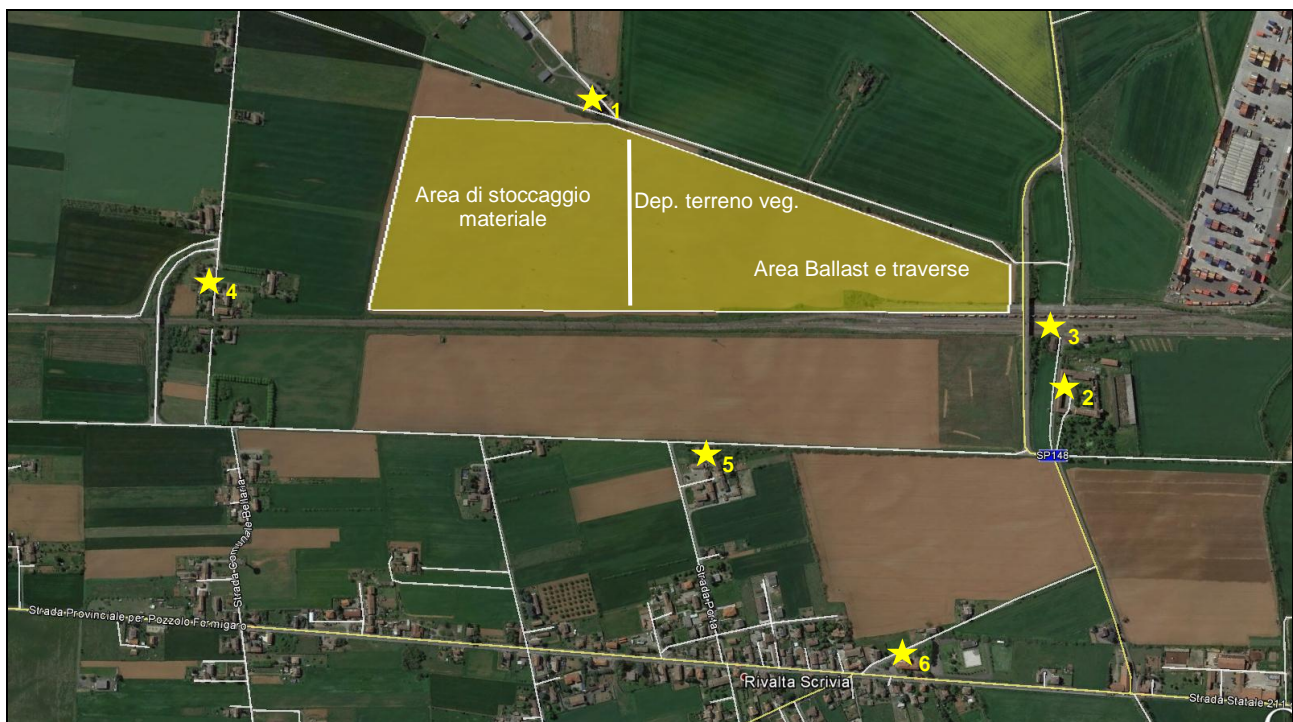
Perimetrazione cantiere e localizzazione degli edifici maggiormente esposti
